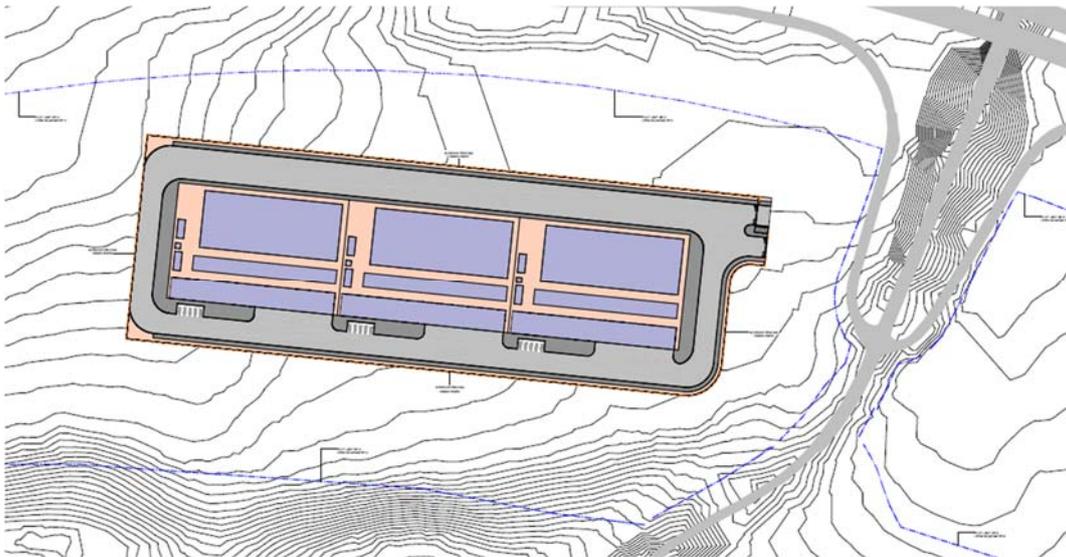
imágenes de los Planos de Pavimentos (Proyecto de Urbanización Privada Interior)
